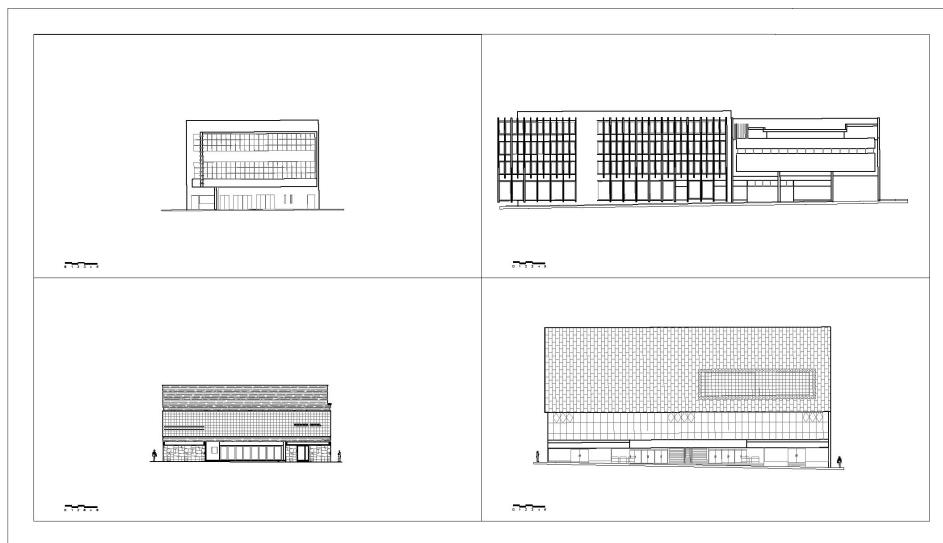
Fachadas de fijación. Teatros Bogotá y Royal Center.
